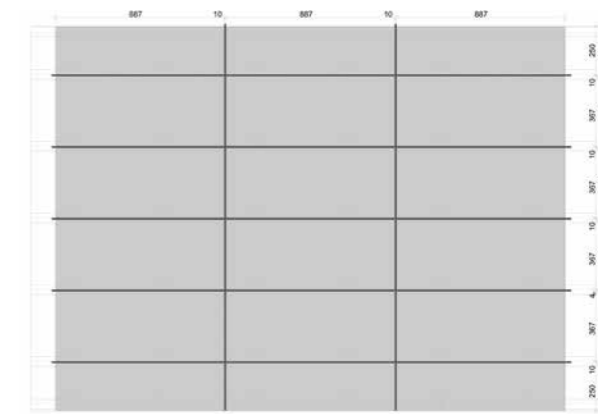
Docięcie elementów brzegowych WALLDESIGN
